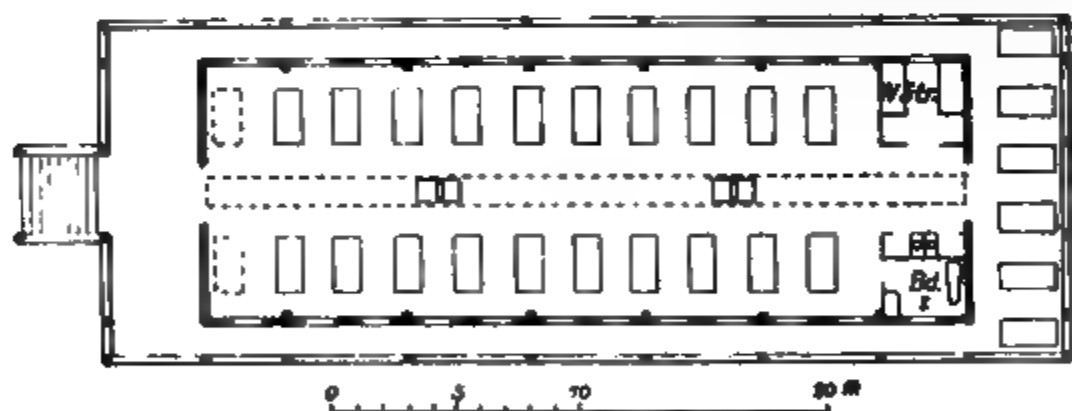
b. Charité-Baracke, Grundriss.
